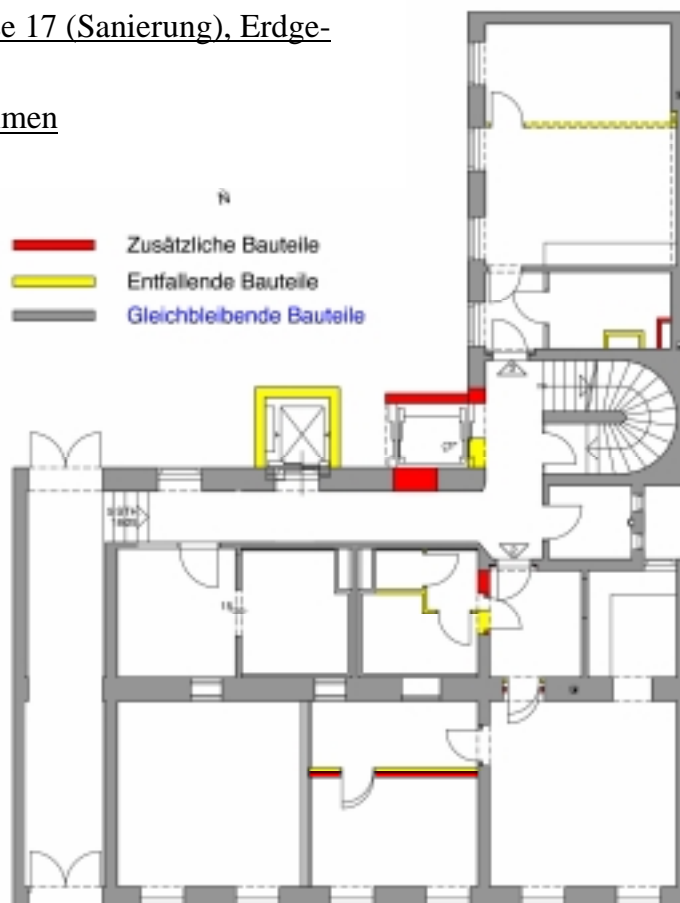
Menzelgasse 17 (Sanierung), Erdgeschoß:
